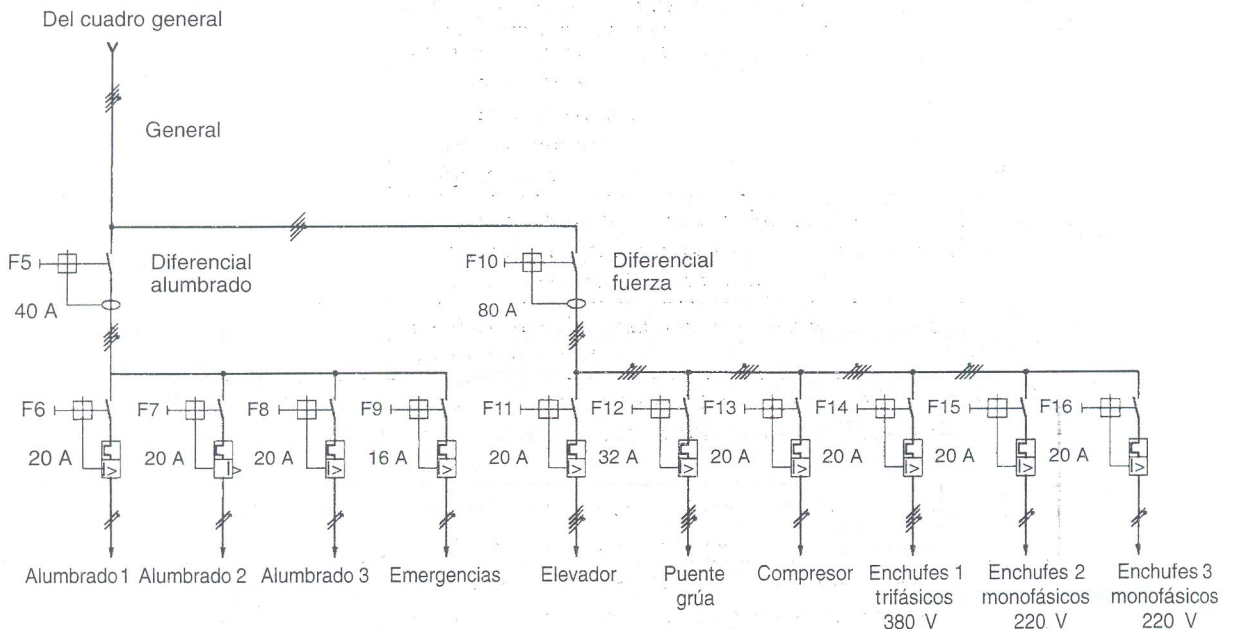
Cuadro planta baja. Taller de reparación.
